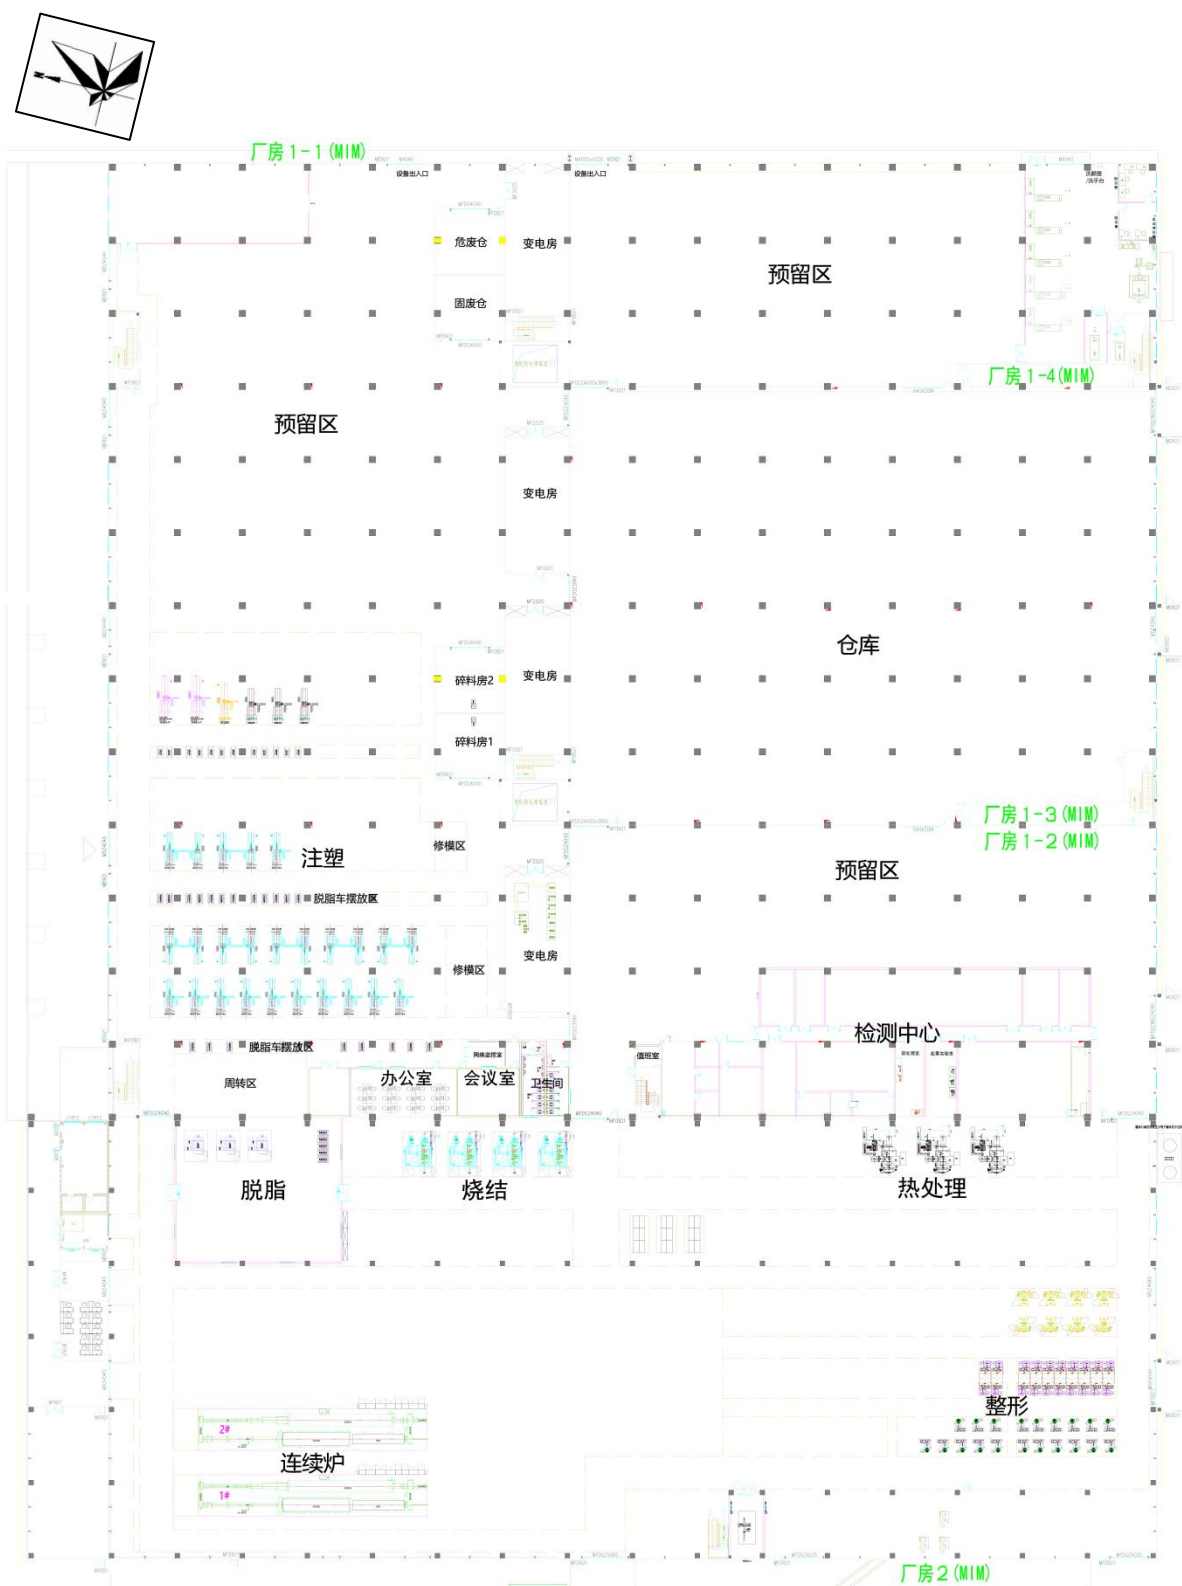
项目平面布置图（厂房 1、厂房 2 一楼）
